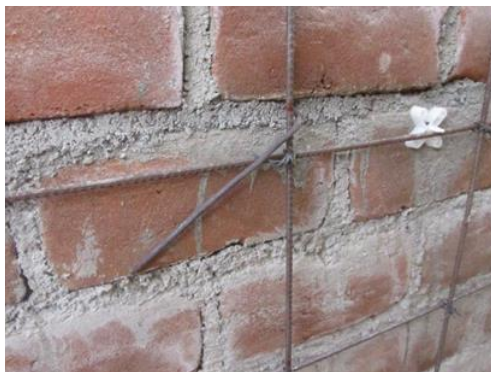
Instalación de alambre N°8 para fijación de malla de acero al muro de albañilería.
